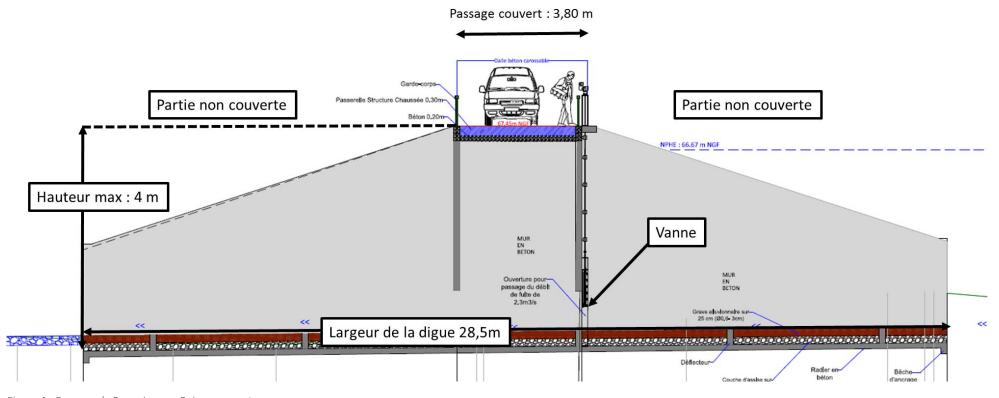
Ouvrage de Beaugie-sous-Bois coupe en travers
